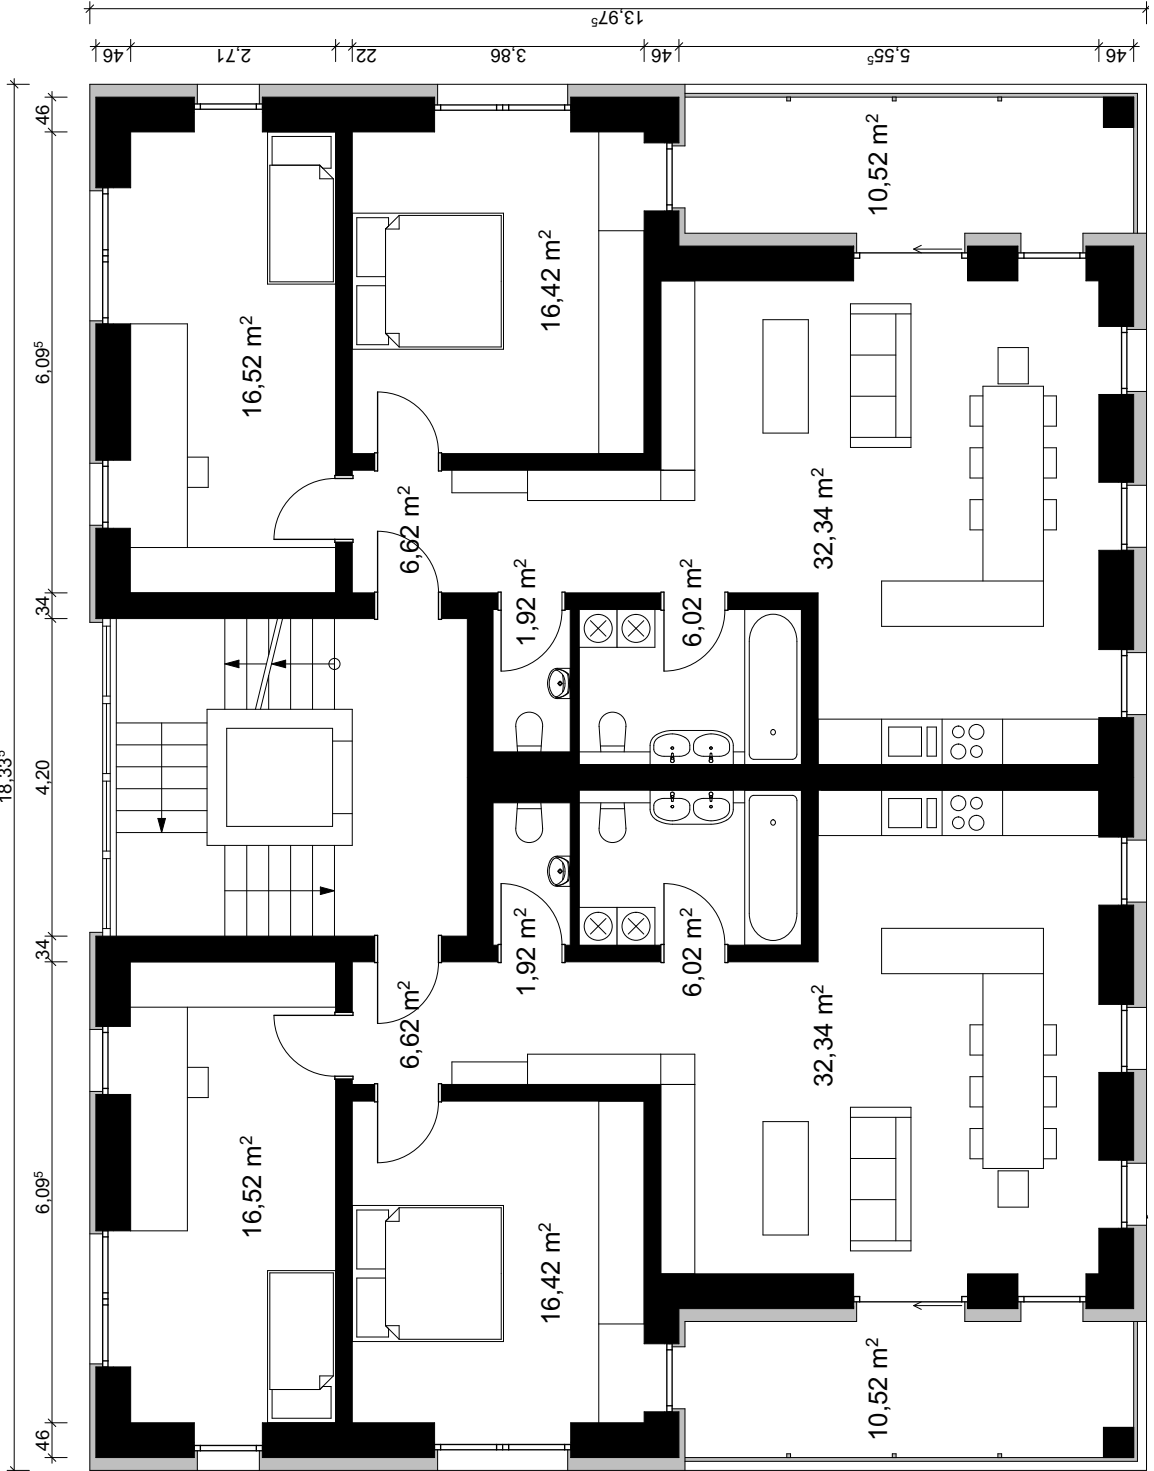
Grundriss 1. und 3. Obergeschoss M 1:100
